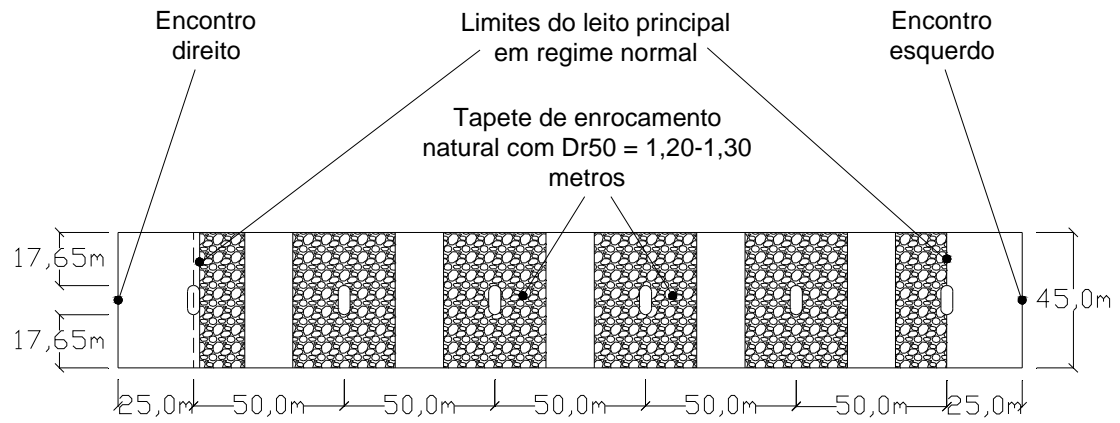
Vista em planta do enrocamento natural para a protecção dos pilares da Antiga Ponte Hintze Ribeiro (Escala em planta não distorcida).
